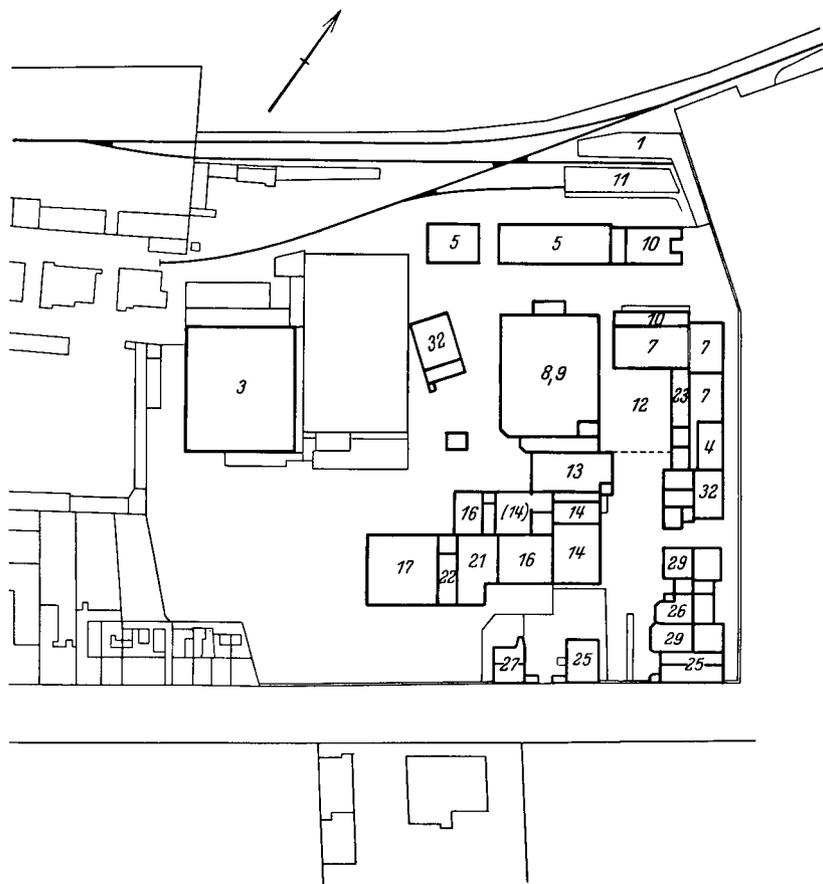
Lageplan der alten Anlage (München-Gladbach).
